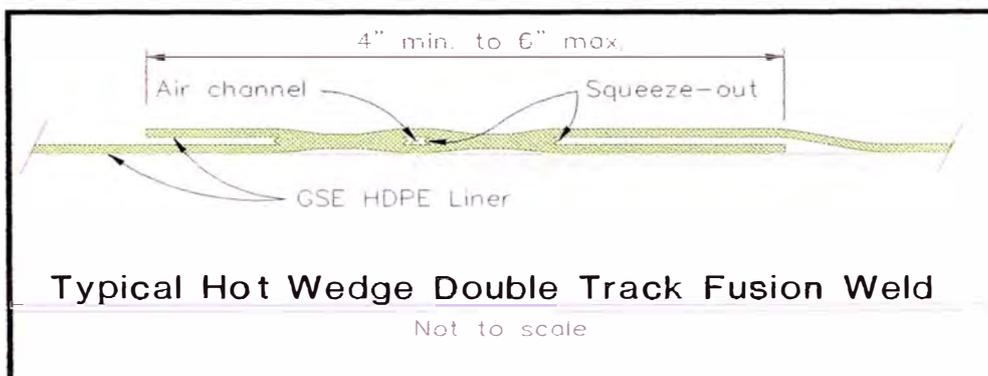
Equipo de Soldadura por Termofusión
